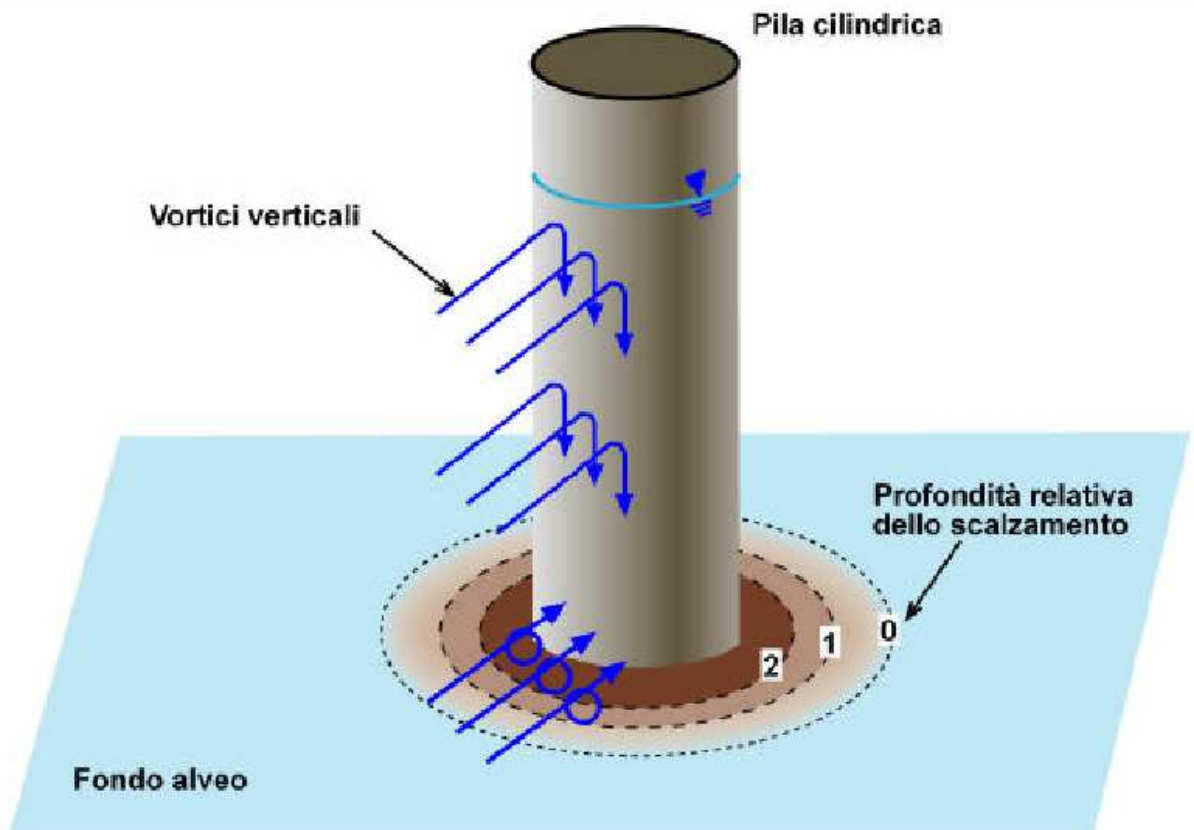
Schema del fenomeno dello scalzamento locale dovuto alla pila
